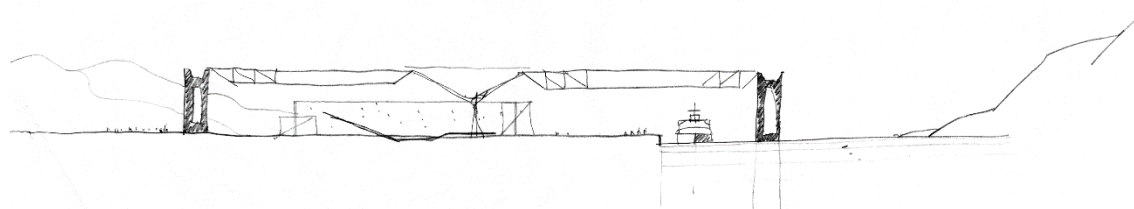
Corte transversal do pavilhão de convenções e exposições. Fonte: ROCHA, 2006.
